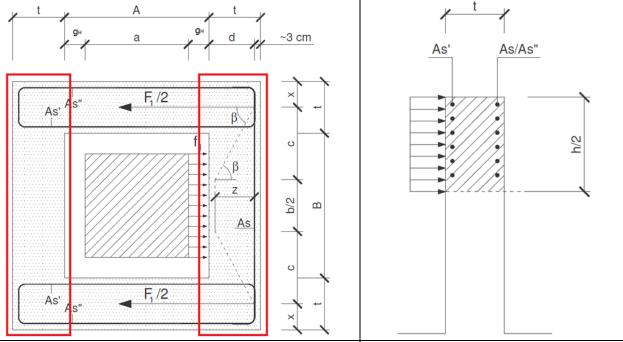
spallette oggetto di verifica lungo X con schema tirante puntone
